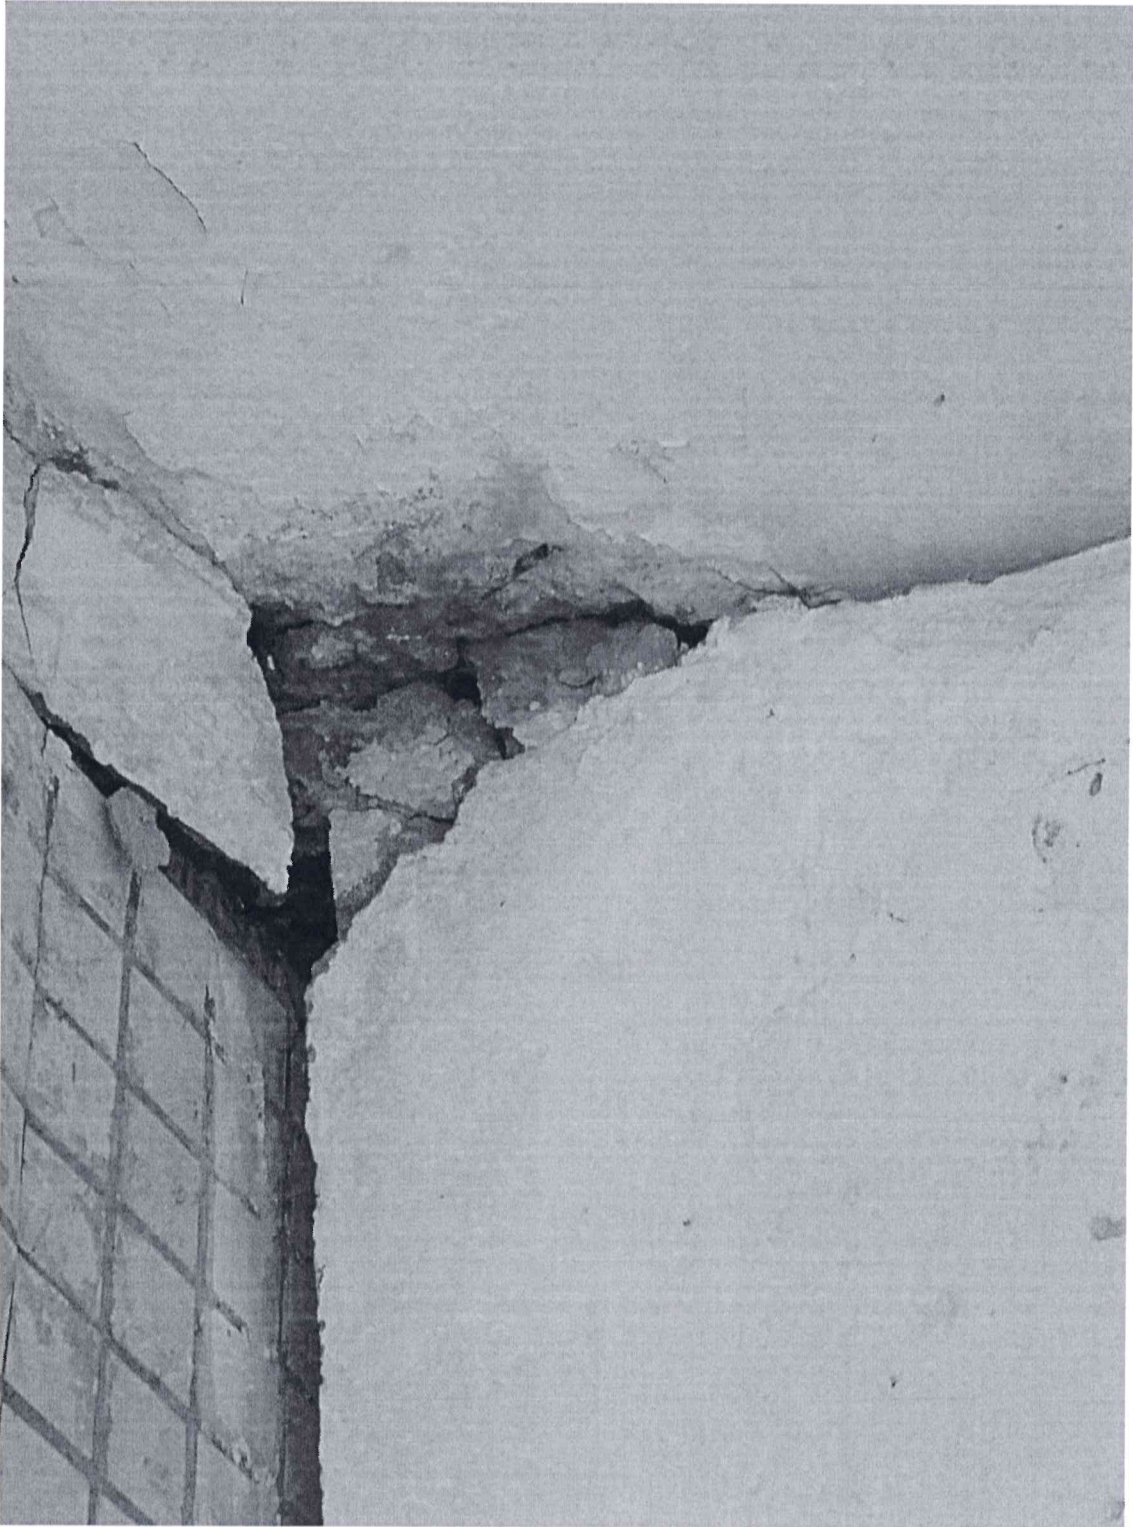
Подъезд №7. Разрушение бетона закладной детали панели (козырька) и смещение по линии опоры. Осадка вертикальной панели.
